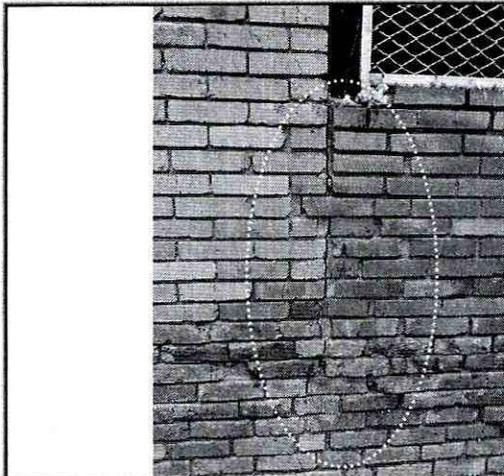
Se observan algunas fisuras en el muro de cerramiento.
